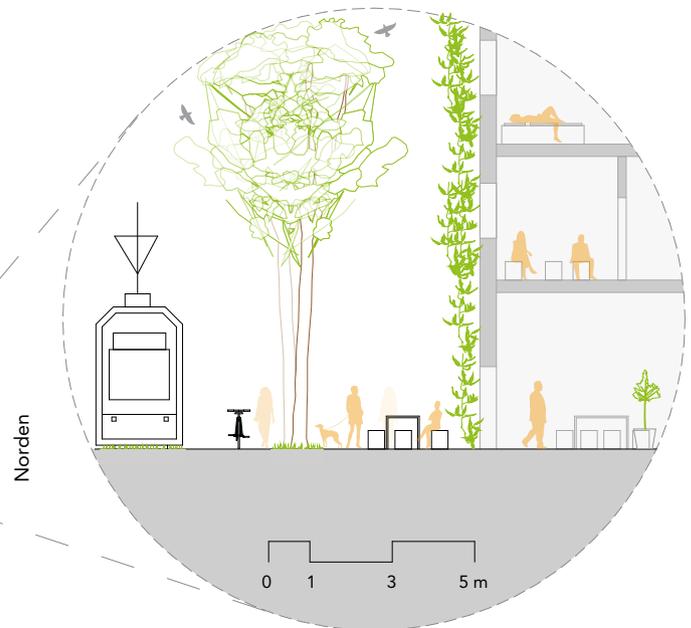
Detaillierter Ausschnitt des Straßenschnittes
